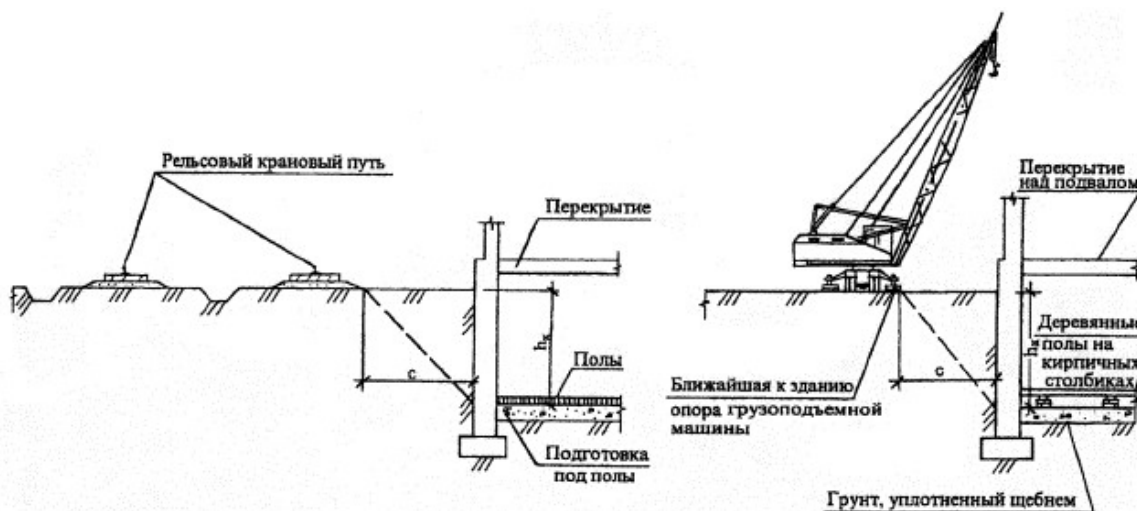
Схема установки крана у стен подвала без проведения расчёта на выдавливание грунта от крановых нагрузок
